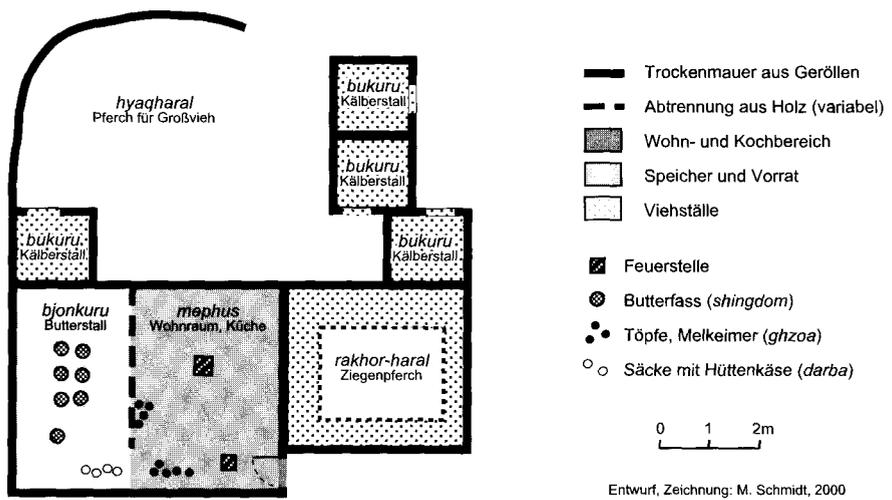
Grundriss eines Hochweidegehöfts (*kuru*) mit angegliederten Ställen (*hara*)
